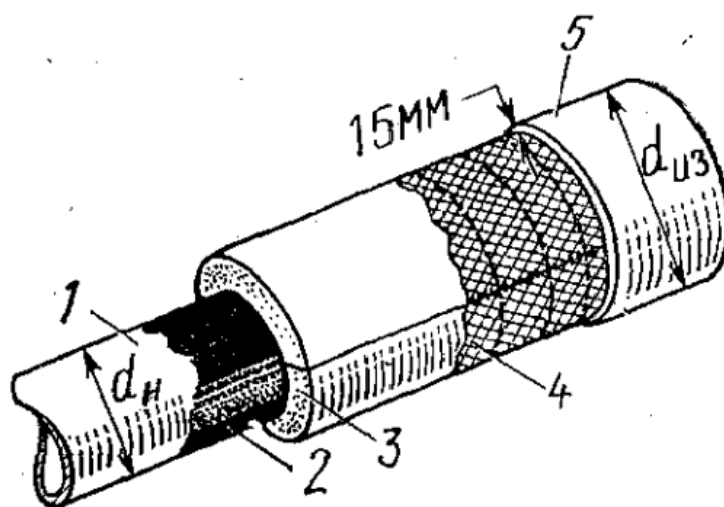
Принципиальная схема теплоизоляционной конструкции: 1 – труба; 2 – антикоррозионное покрытие; 3 – мат из минеральной ваты (основной теплоизоляционный слой); 4 – стальная сетка; 5 – асбоцементная штукатурка
